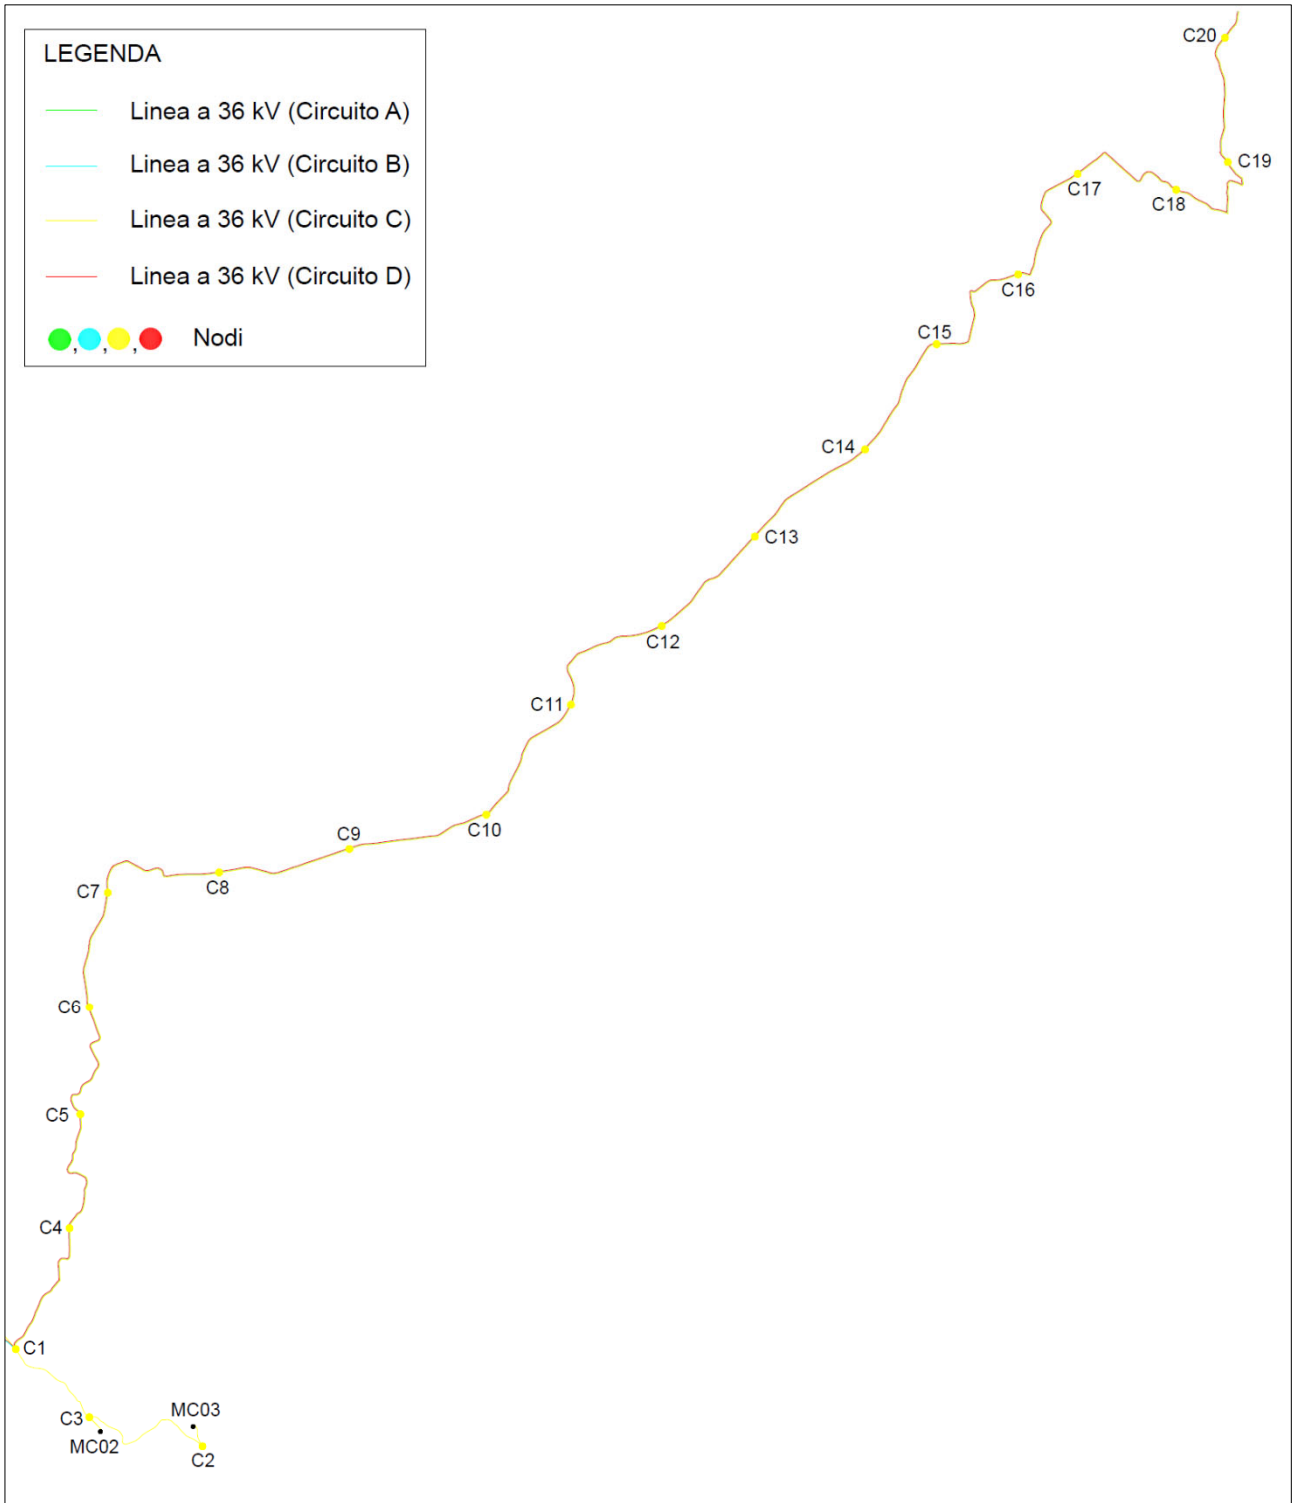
Dettaglio 2 della planimetria di distribuzione linee a 36 kV
